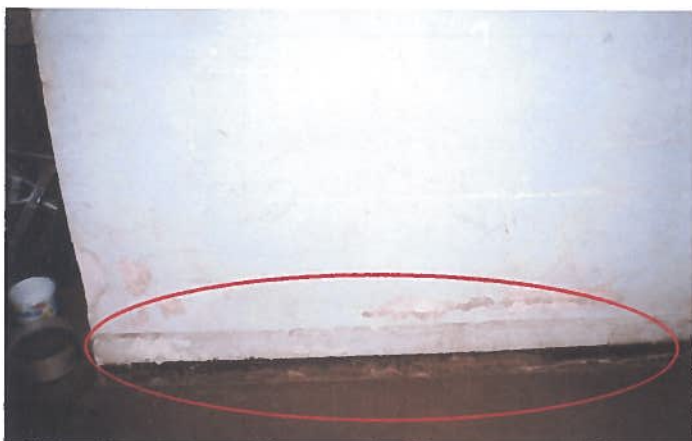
Habitação 13: marcas de infiltrações na base da parede, oriundas da falta de impermeabilização da viga baldrame.
